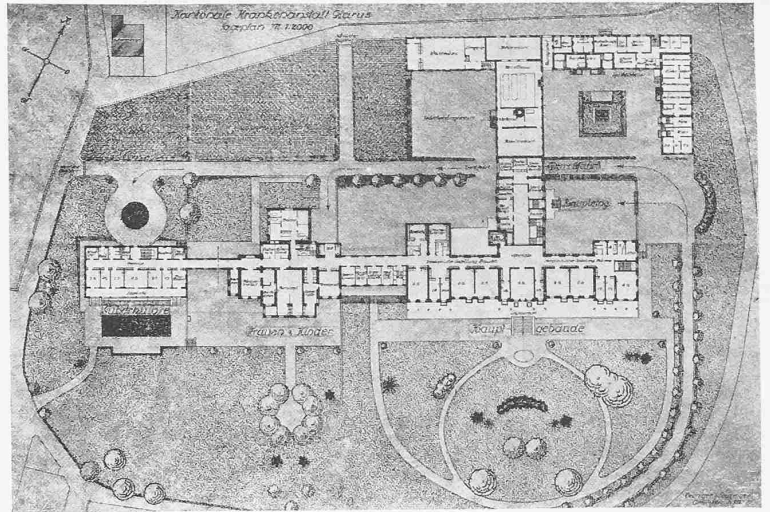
Lageplan des um- und ausgebauten Spitals. — Masstab 1 : 2000.
